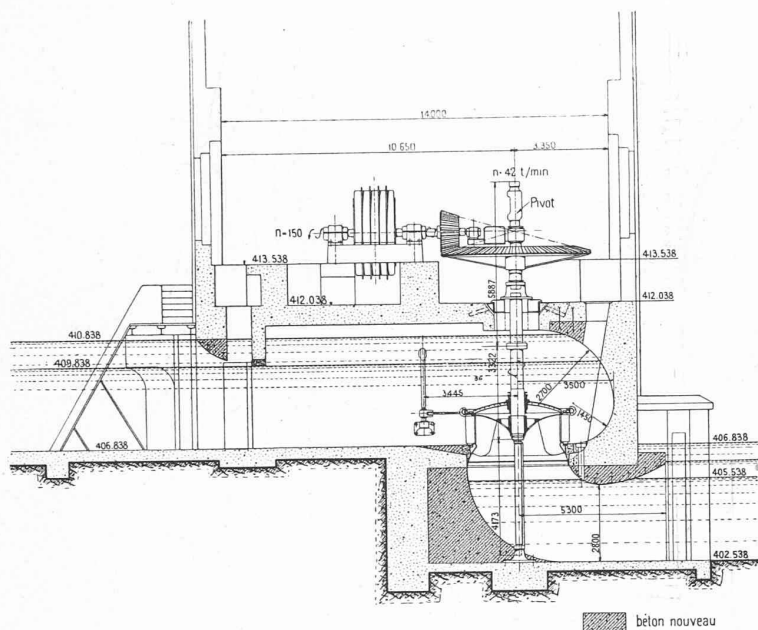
Plan d'installation de la turbine de Wynau. — Coupe en long.
